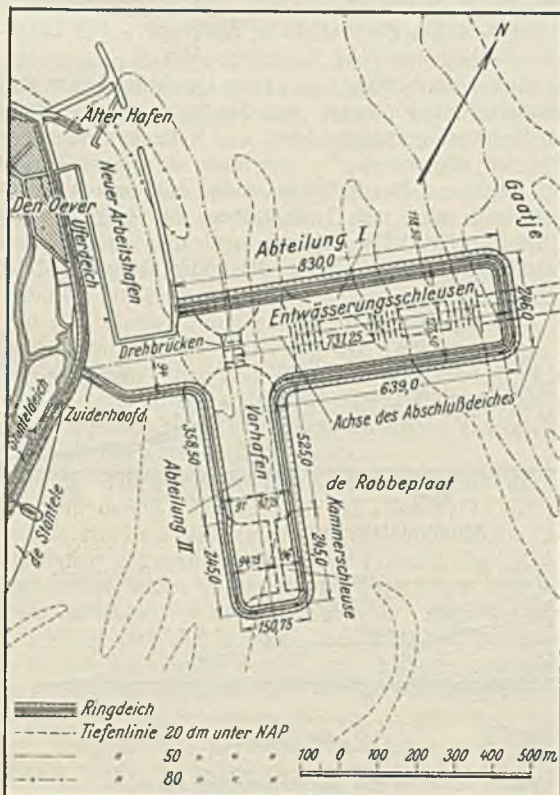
Grundriß des Ringdeiches der Schleusenbaugrube östlich Wieringen.
